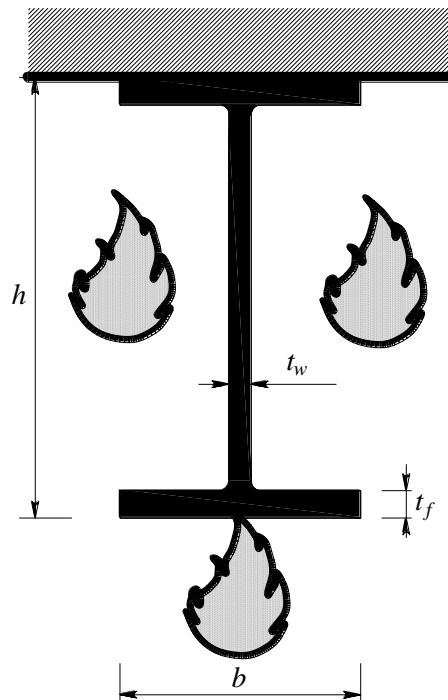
Расчетная схема огневого воздействия на балку перекрытия
